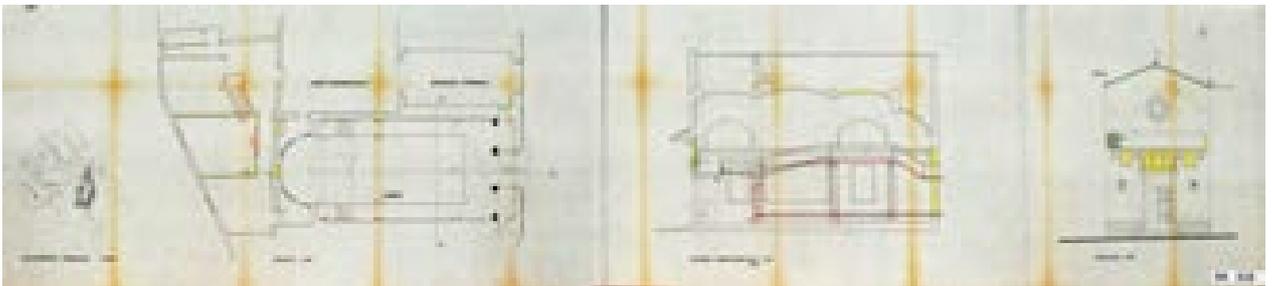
Pianta +0,00, prospetto e sezione XX, Giovanni Michelucci\*\*– stato sovrapposto - s.d. (AABS-94.038)
